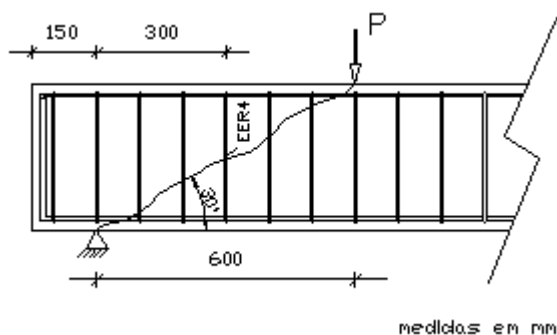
Extensômetros nos estribos das vigas VM3, VPF1, VPF2 e VPF3
